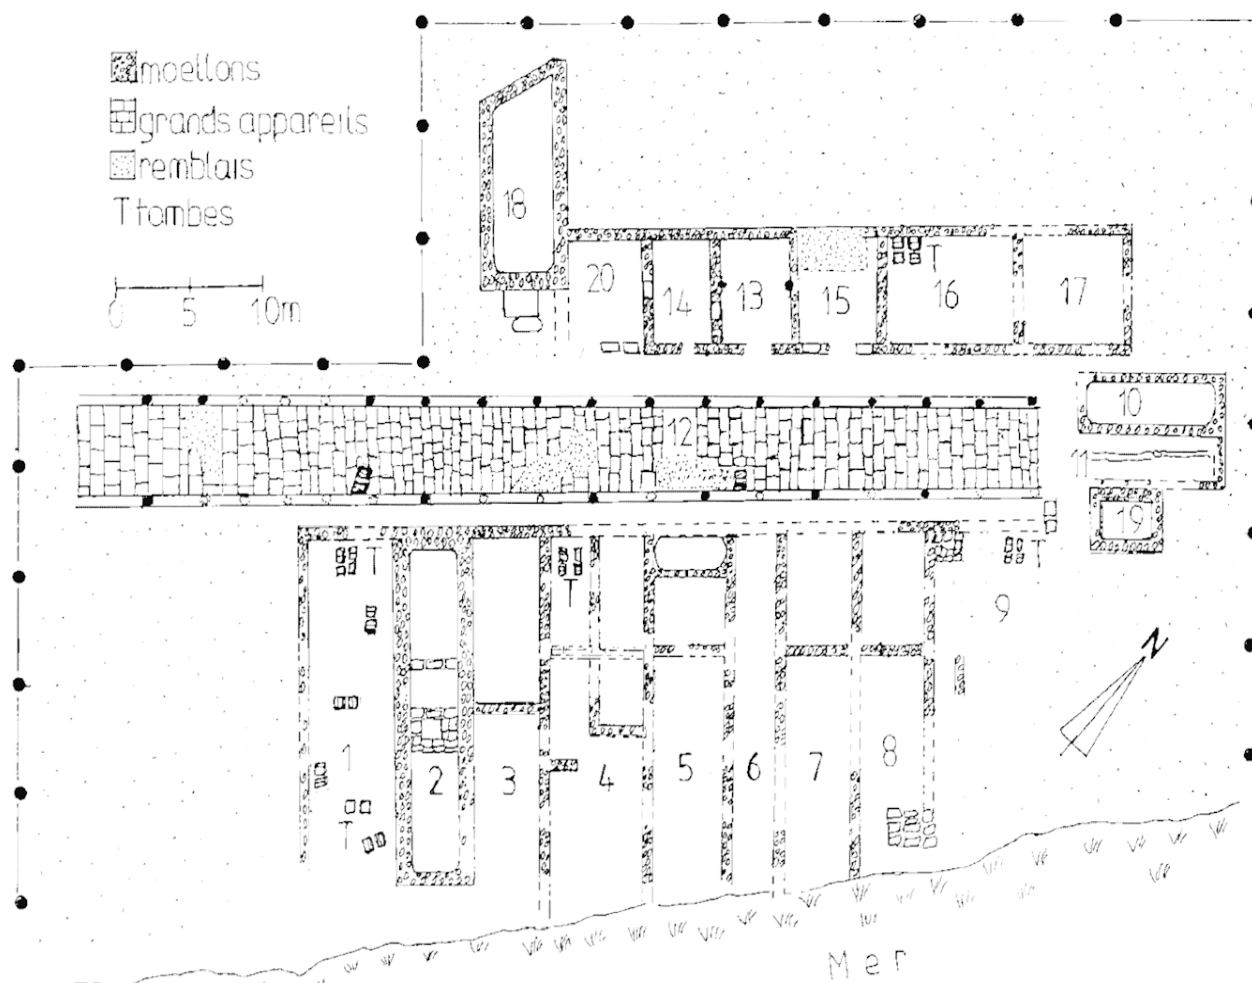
Plan des entrepôts (fouilles 2000-2006).
